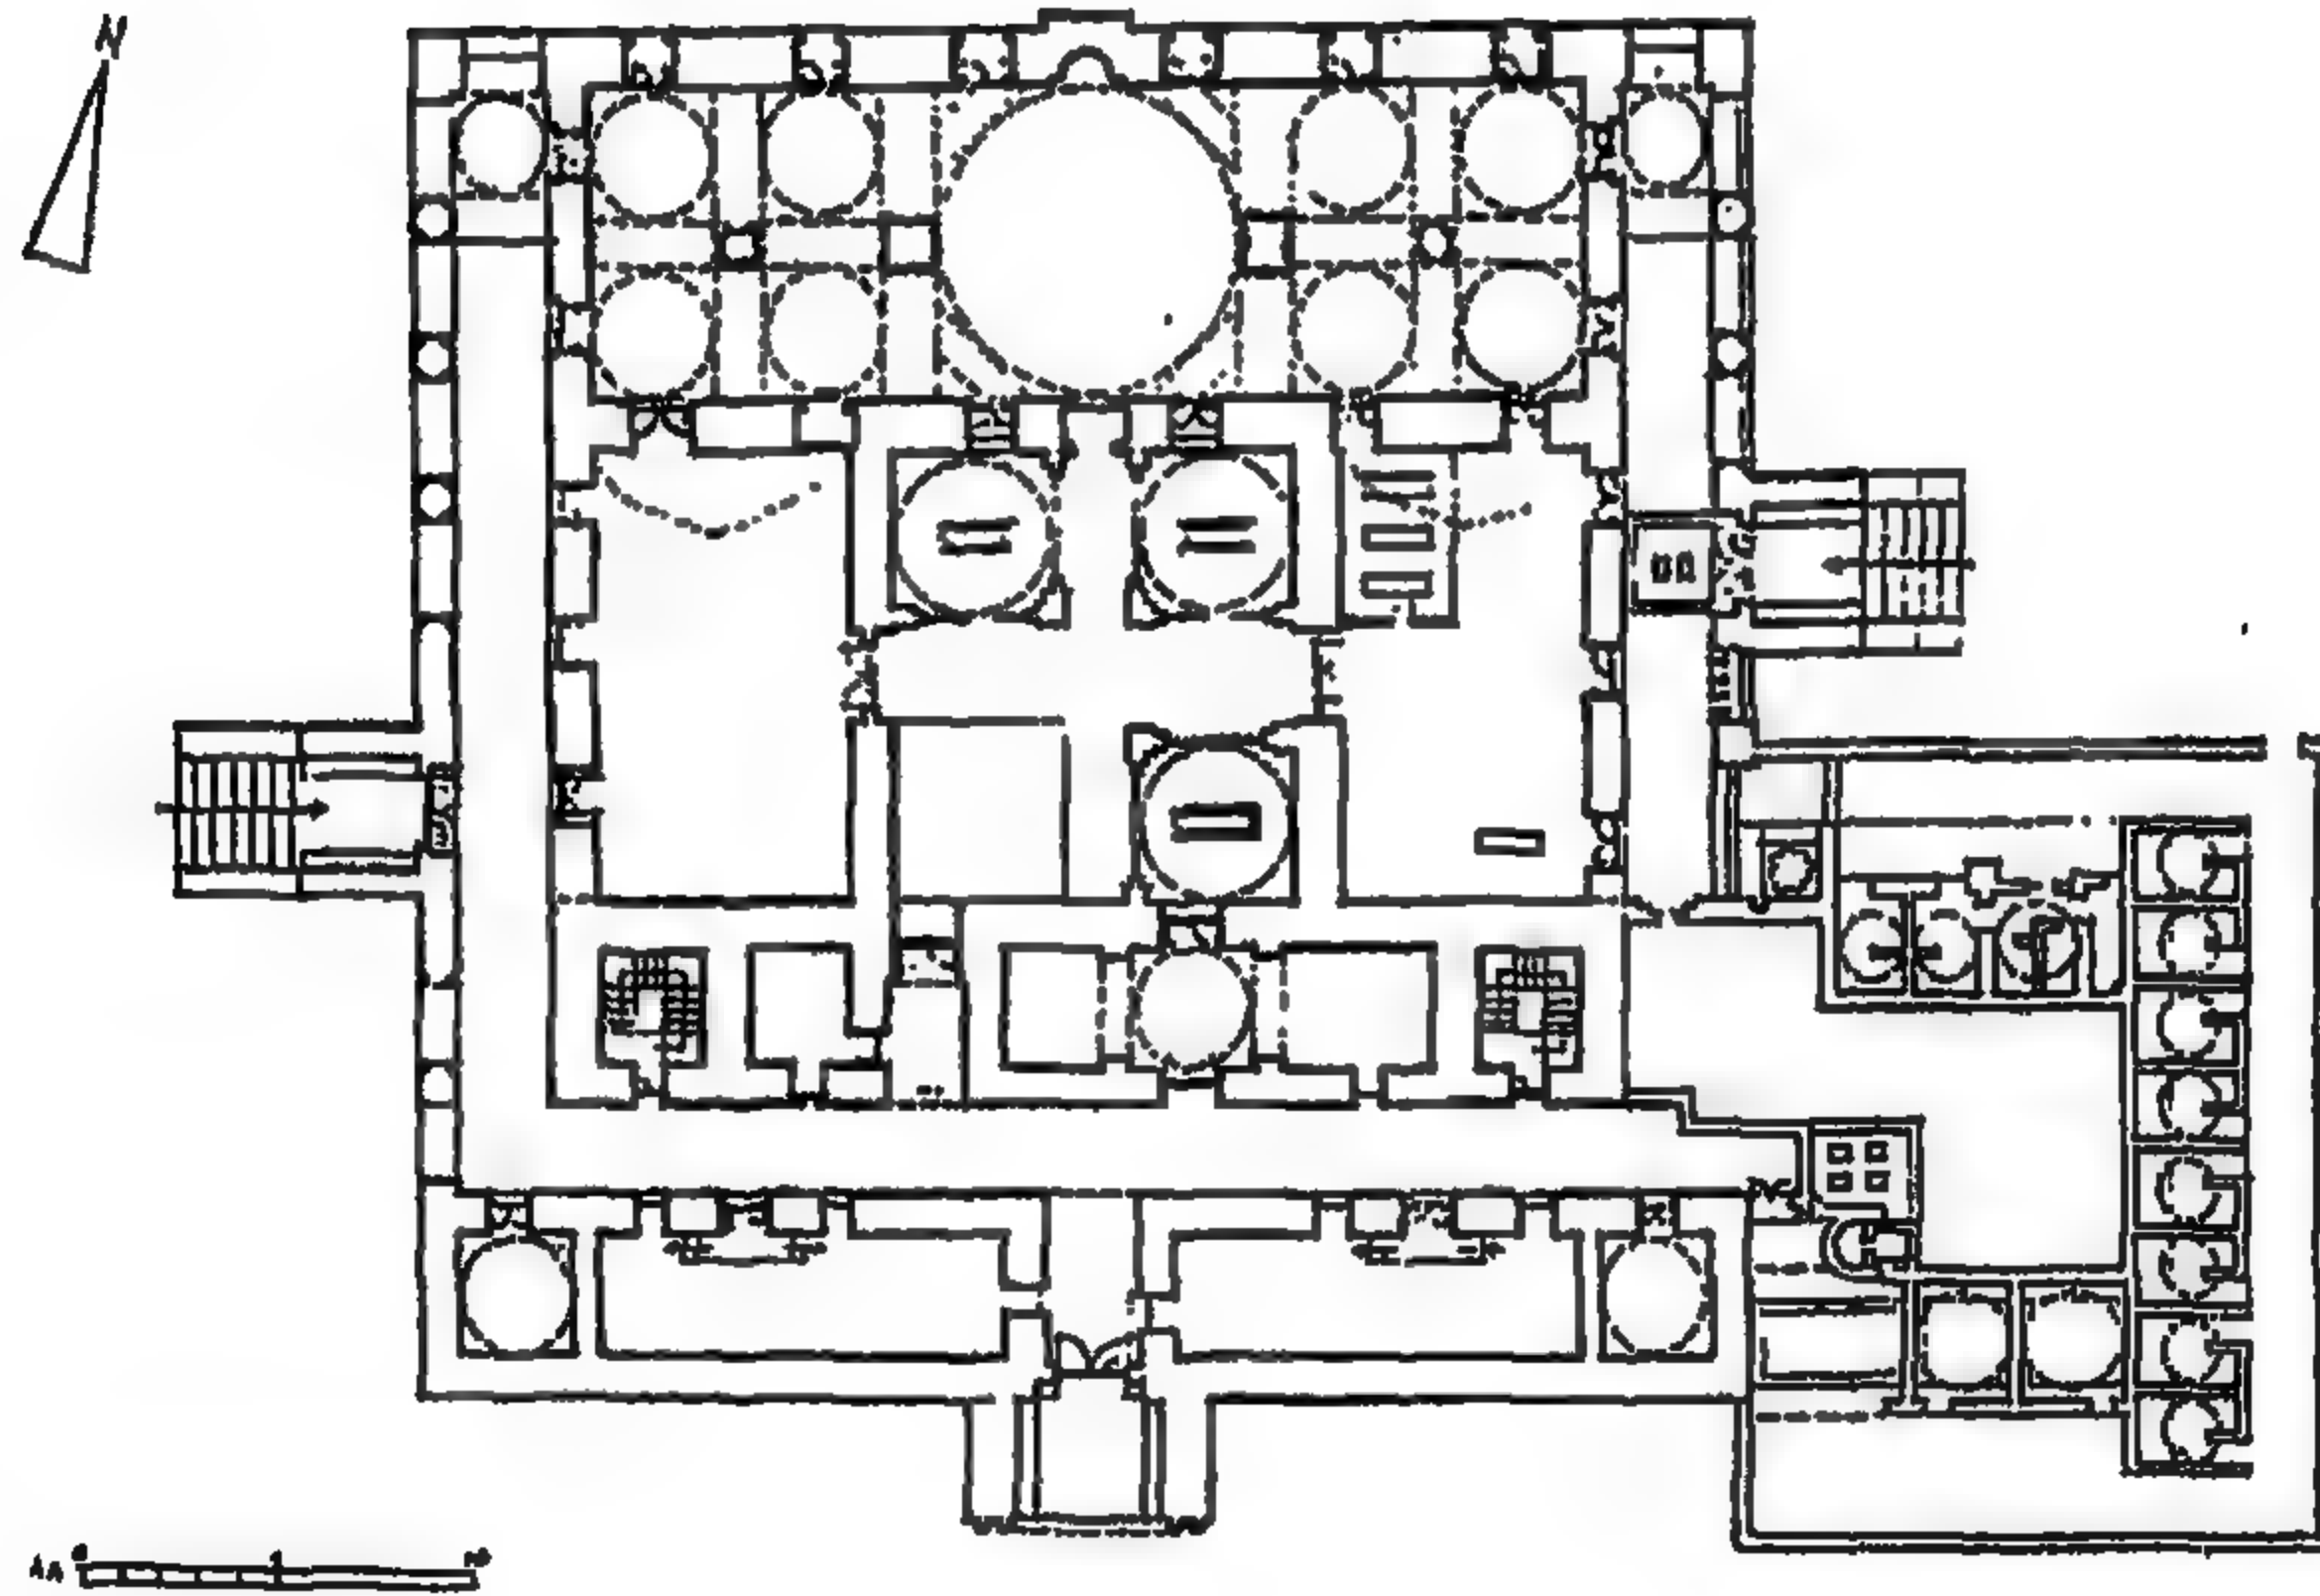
مسقط أفقى للجامع الكبير بالمخلاف (عن Itallan Institute)
